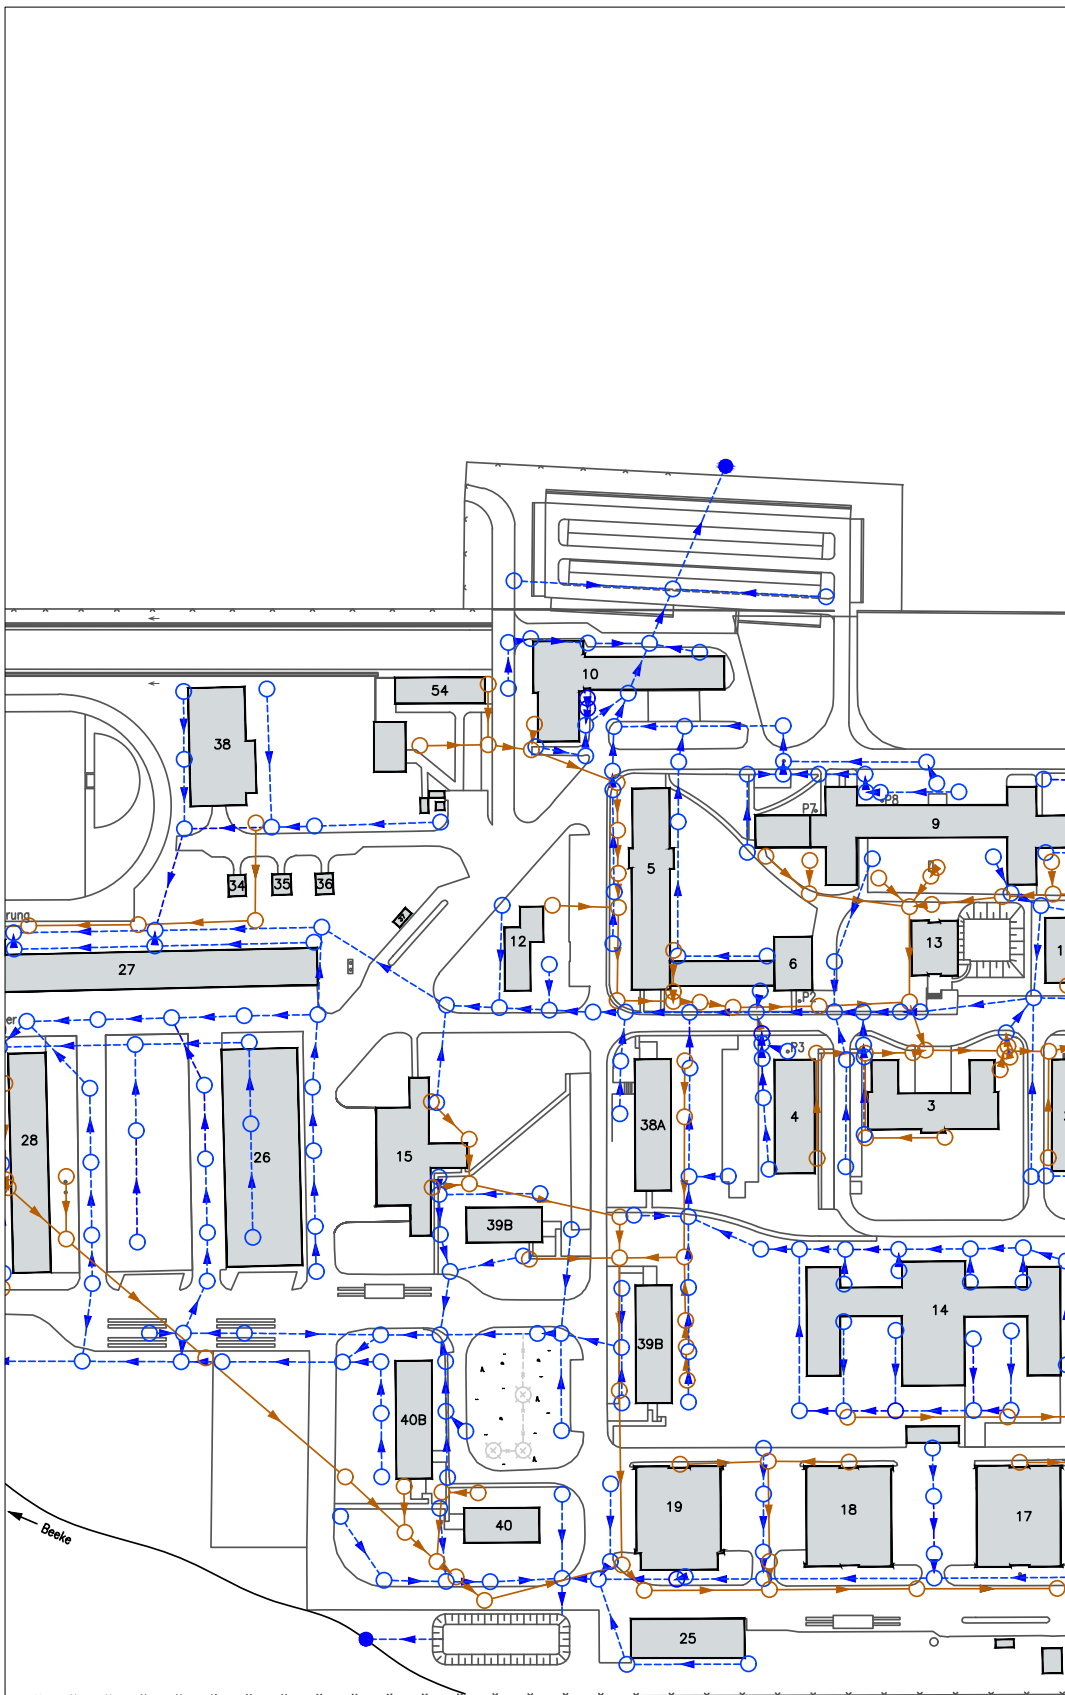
Beispielplan: Übersichtslageplan „Bestand“
